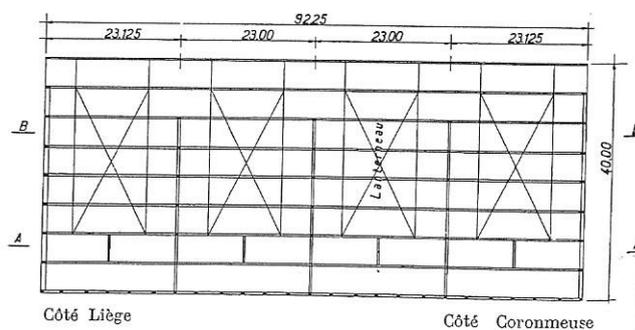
VUE EN PLAN DE L'ENSEMBLE DE LA TOITURE DU BÂTIMENT.
